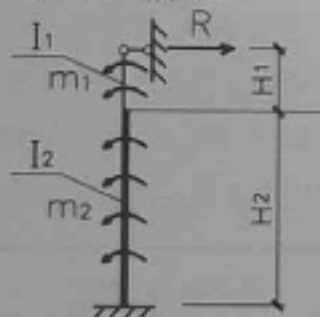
山墙抗风柱受墙体自重的偏心弯矩荷载计算简图
